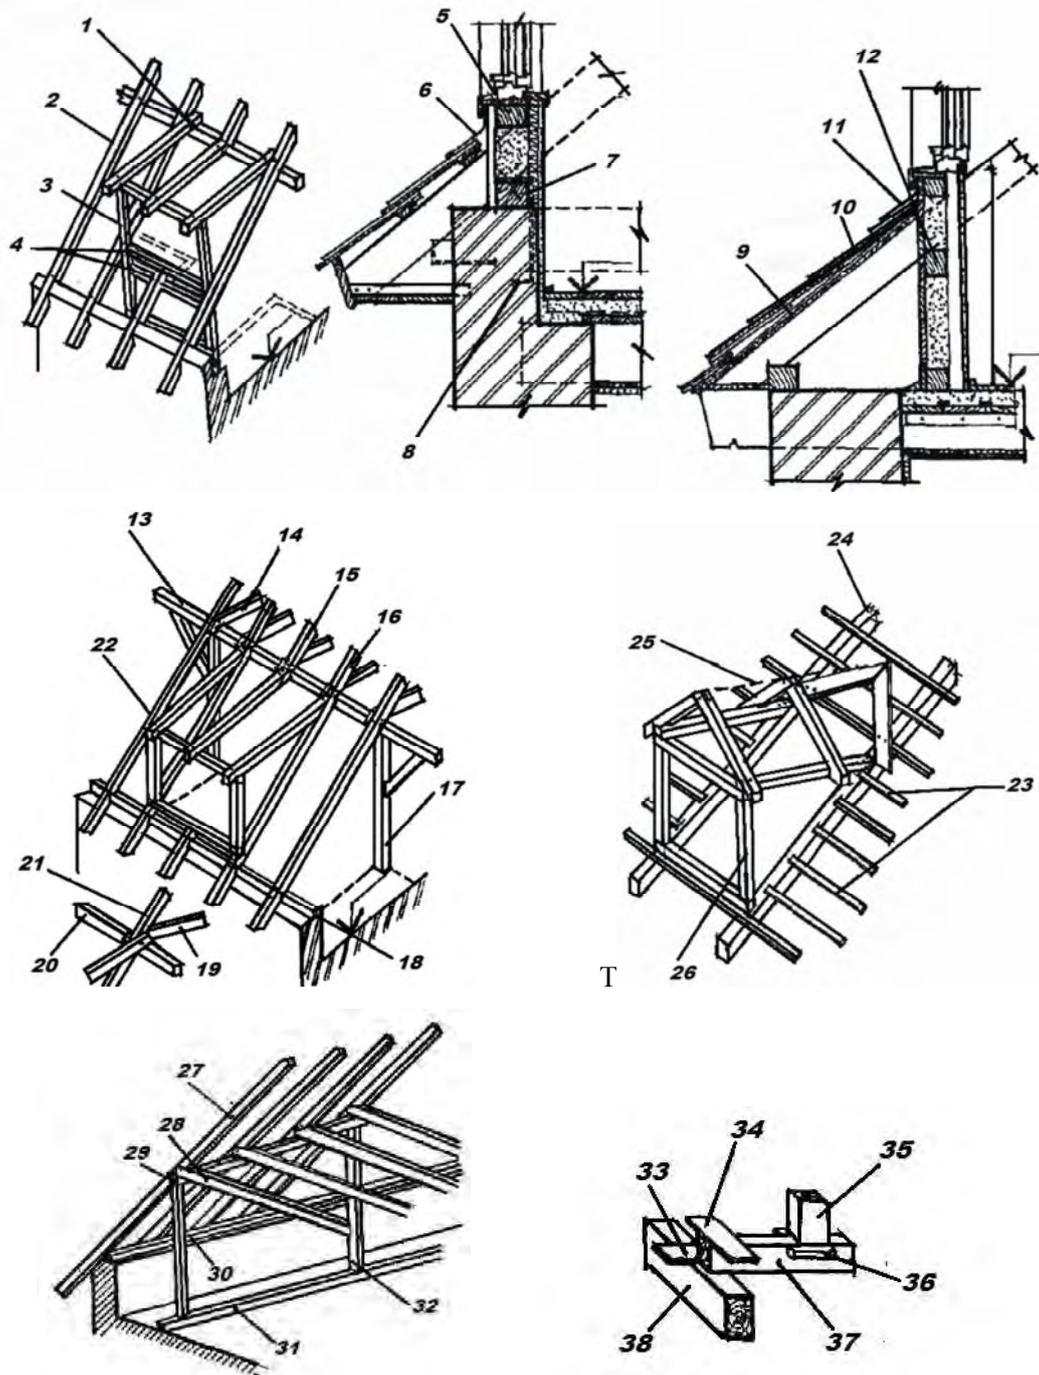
Фрагменты стропильной системы: 1, 13, 20, 29 — прогон; 2, 16, 21, 22, 24 — стропильная нога; 3, 17, 26, 27, 32, 35, 36 — стойка; 4, 5, 12 — горизонтальный ригель; 6 — тонкая листовая сталь, жесь; 7, 18, 30 — мауэрлат; 8 — стальной анкер; 9 — толь; 10 — асбестоцементная плитка; 11 — обшивка из стали; 14, 19, 28 — затяжка; 15 — укороченная стропильная нога; 23 — обрешетка; 25 — конек; 31, 37 — прогон нижний; 33 — накат перекрытия; 34 — доски пола; 38 — балка перекрытия
